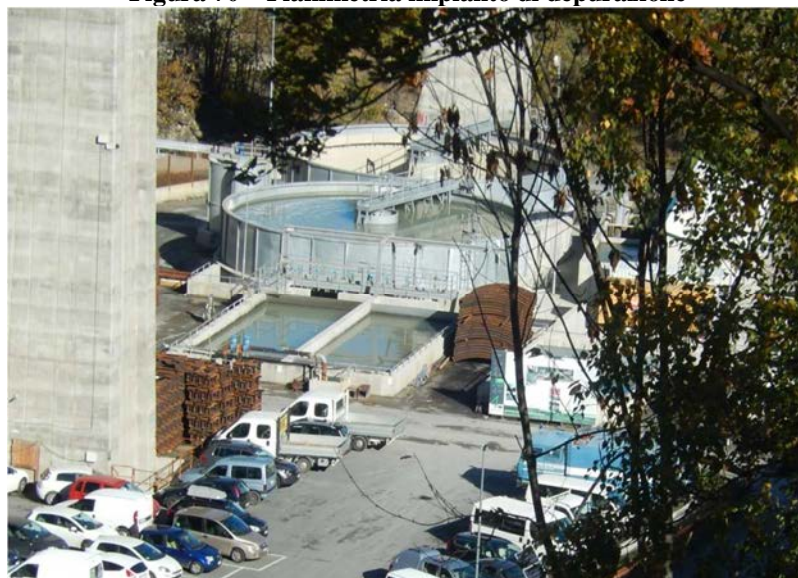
Ripresa fotografica dell'impianto di depurazione del cantiere
